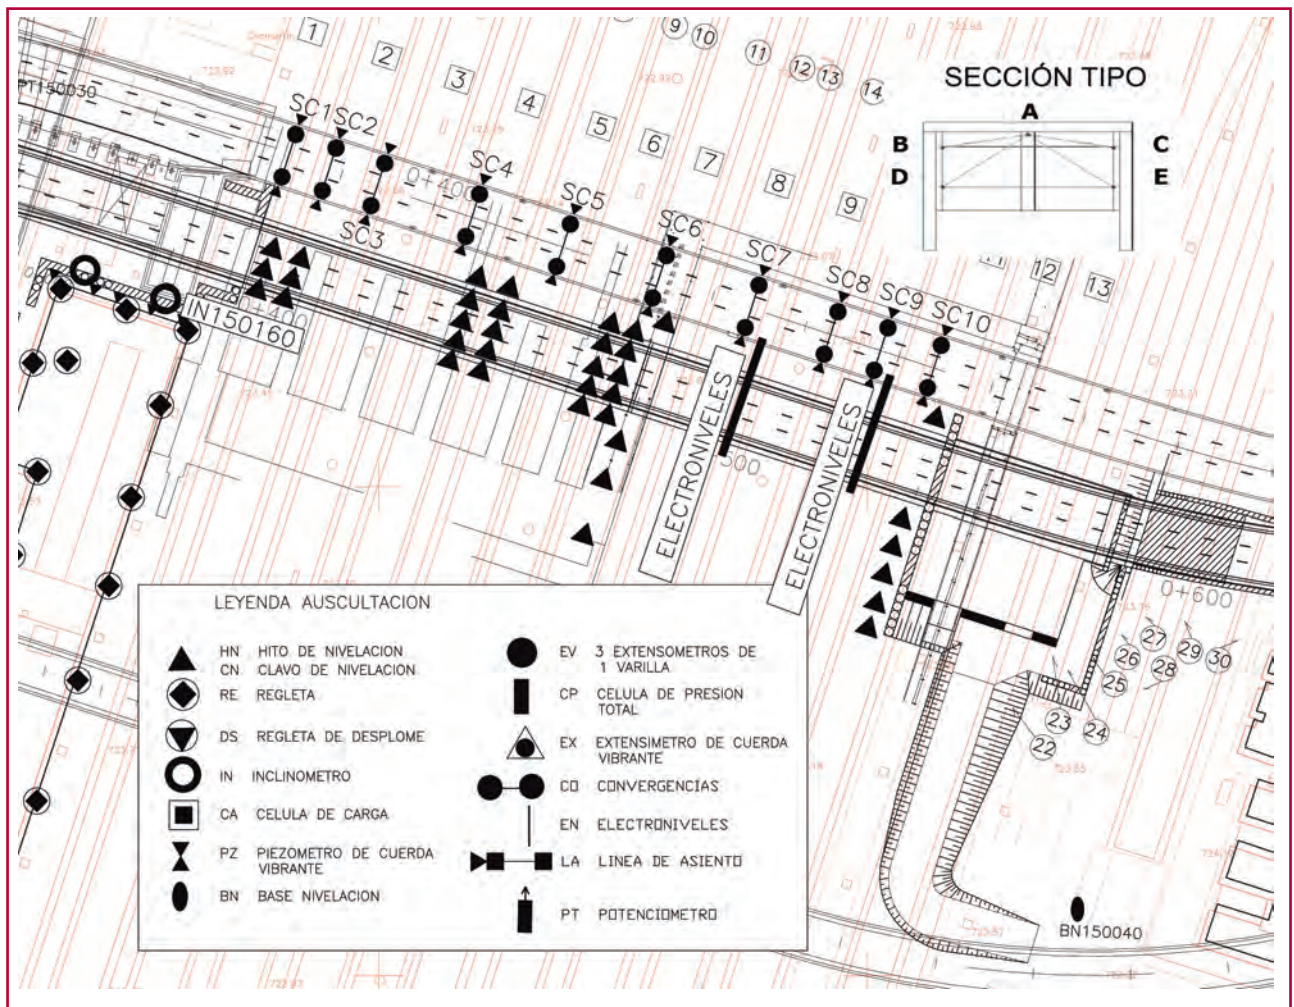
Planta de instrumentación / Instrumentation ground plan.
